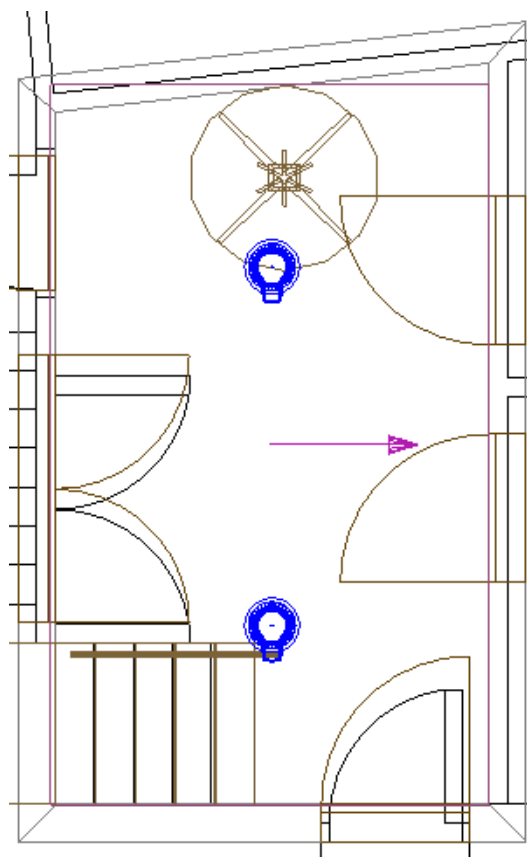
Plano del recibidor de la planta baja de la vivienda unifamiliar.
